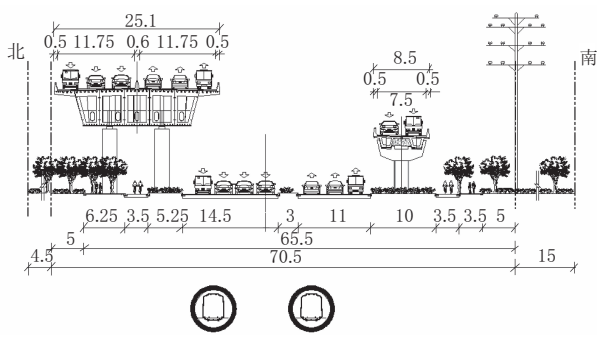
申江路上匝道(东侧)段横断面布置(单位:m)
